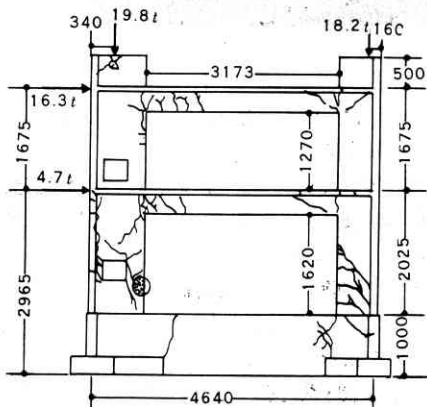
c B 構面のひび割れおよび破壊時の加力 (寸法 mm) 注: ○印の部分がげ曲によって圧縮破壊を起こした
